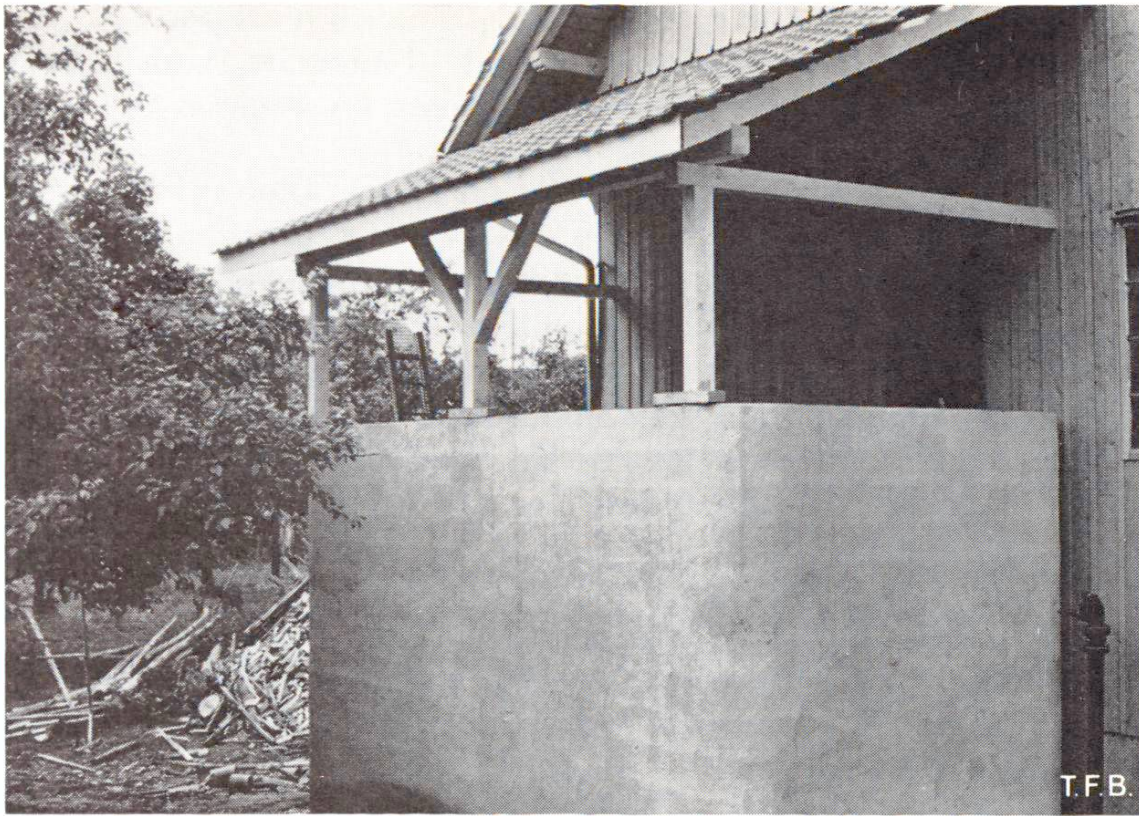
Silo en élévation de forme carrée construit en préfabriqué
